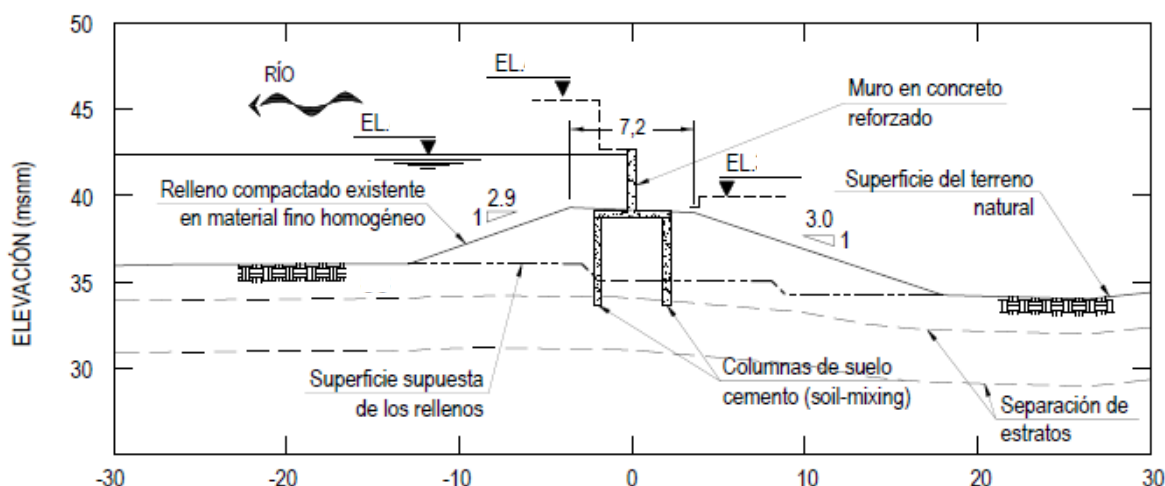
Esquema de alternativa de muro en concreto sobre la cresta del terraplén existente.
